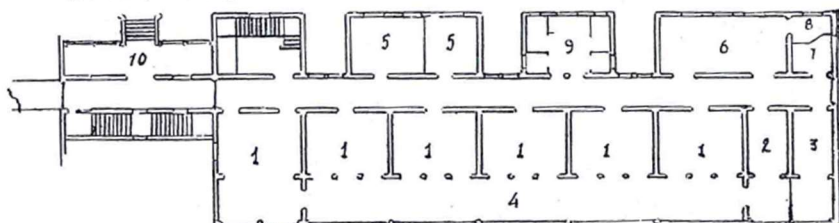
<sup>a</sup>. — Pianta del padiglione gestanti: piano primo.
